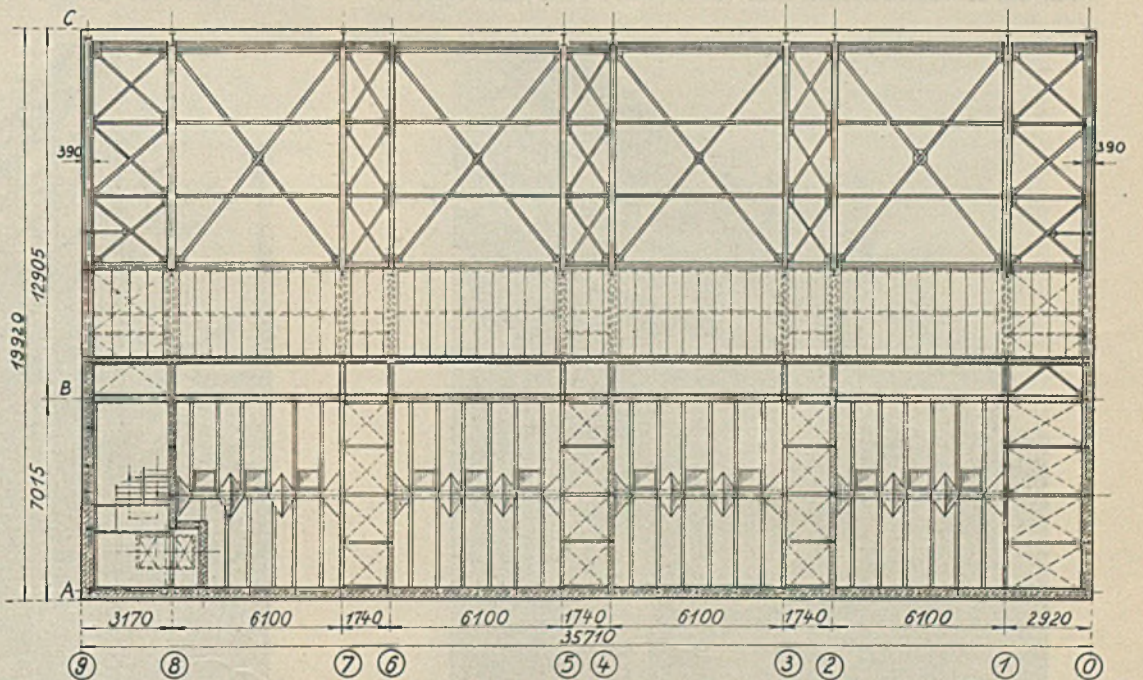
Grundriß des Daches und Schnitt durch den Bunker.
